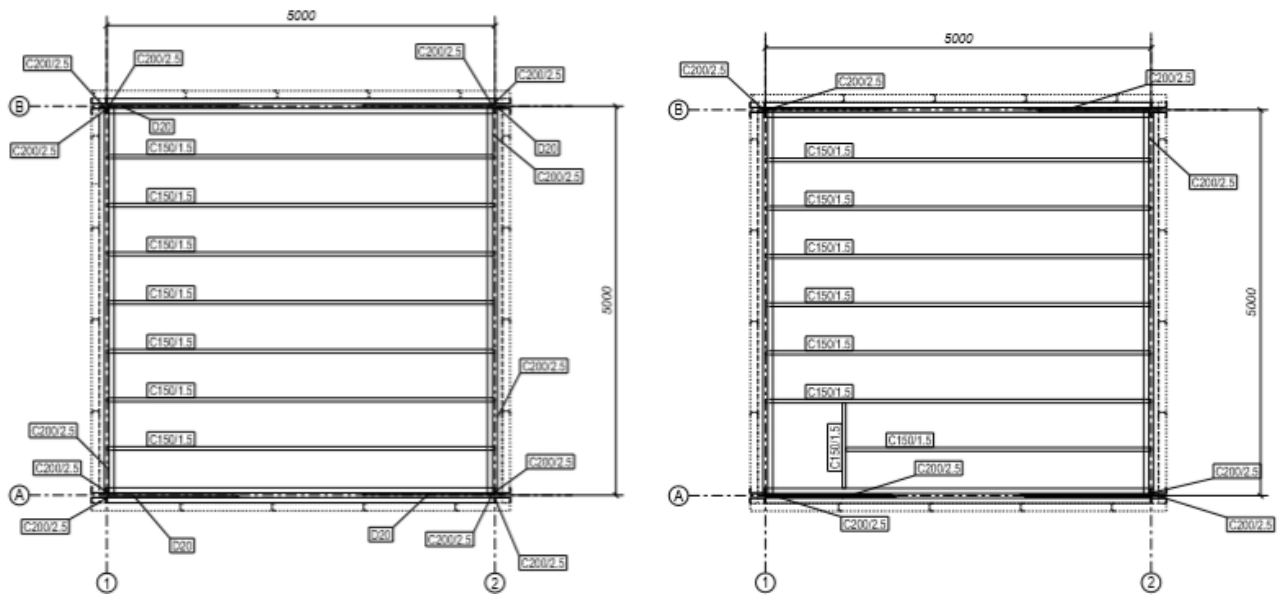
Plan +0,40 (stanga) și Plan +2,85 (dreapta)
